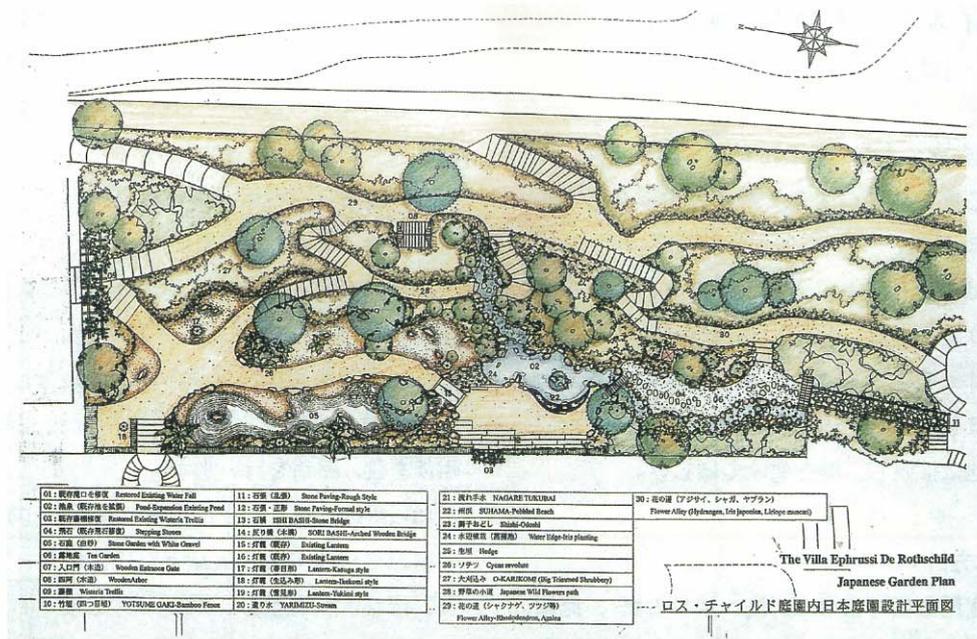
ロスチャイルド美術館内日本庭園修復設計平面図
